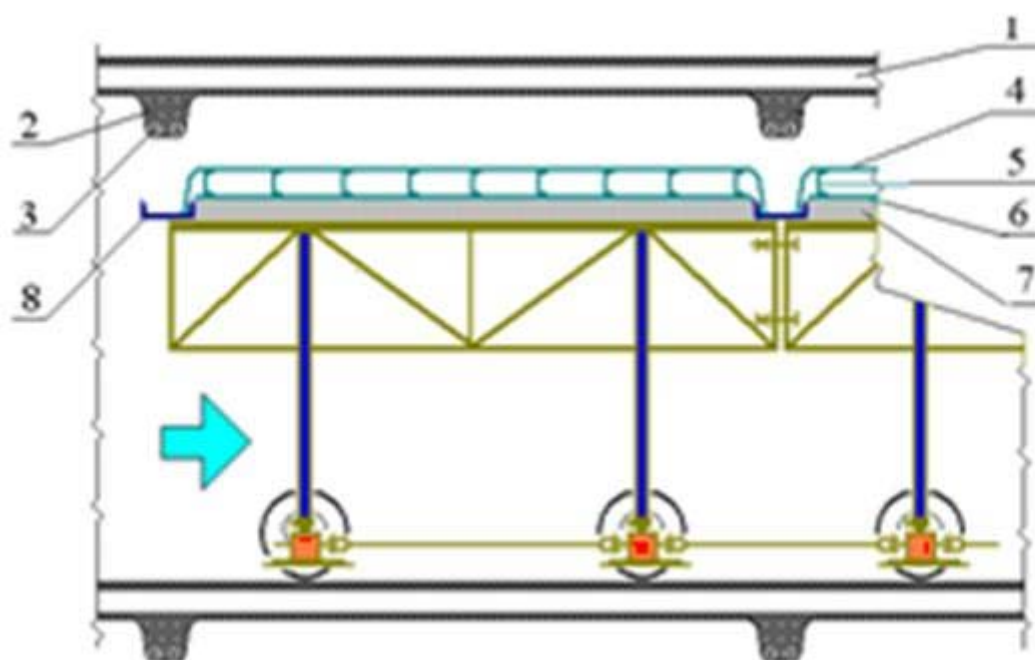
Передвижная форма для строительства монолитного здания Града с пустотными перекрытиями. Пояснения в тексте.
